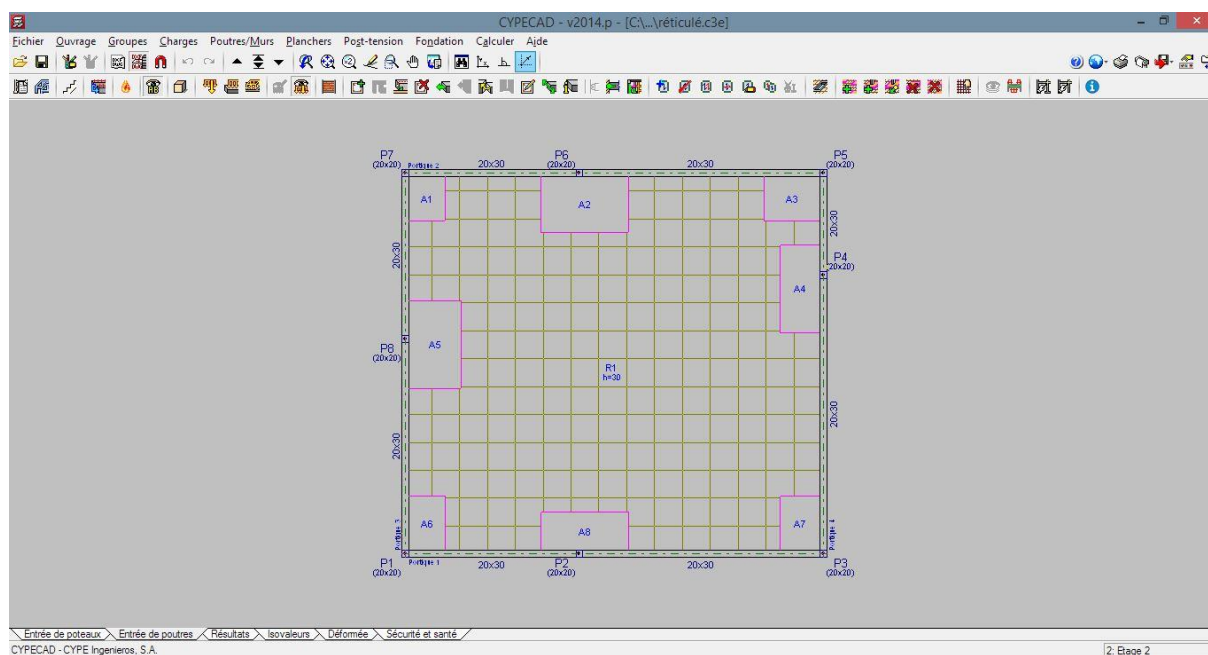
MODELISATION DU JOINT 23 EN DALLE RETICULEE SUR CYPECAD
